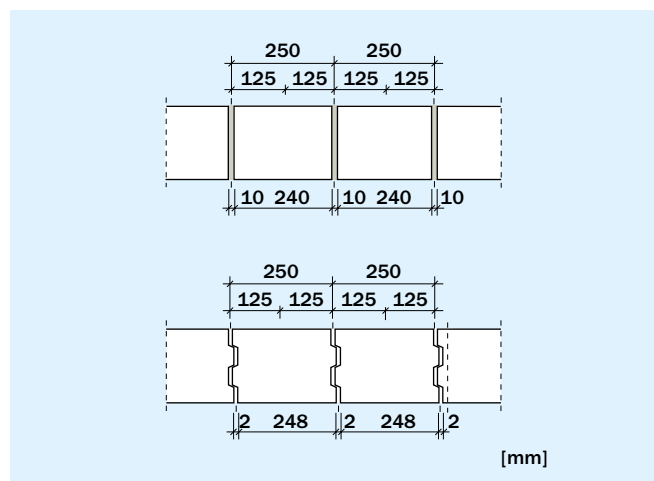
Baurichtmaße von Mauerwerk mit und ohne Stoßfugenvermörtelung
